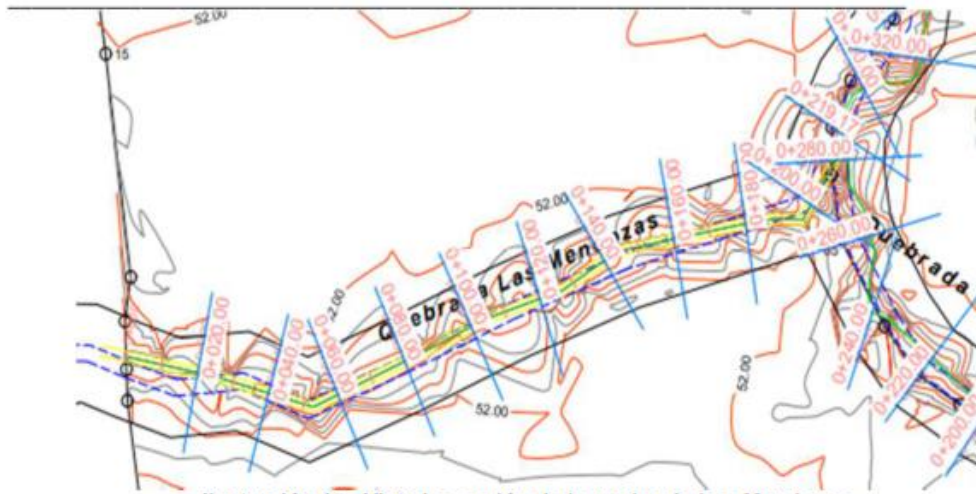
Vista la sección de la quebrada Las Mendozas, que atraviesa la parte central del proyecto.
